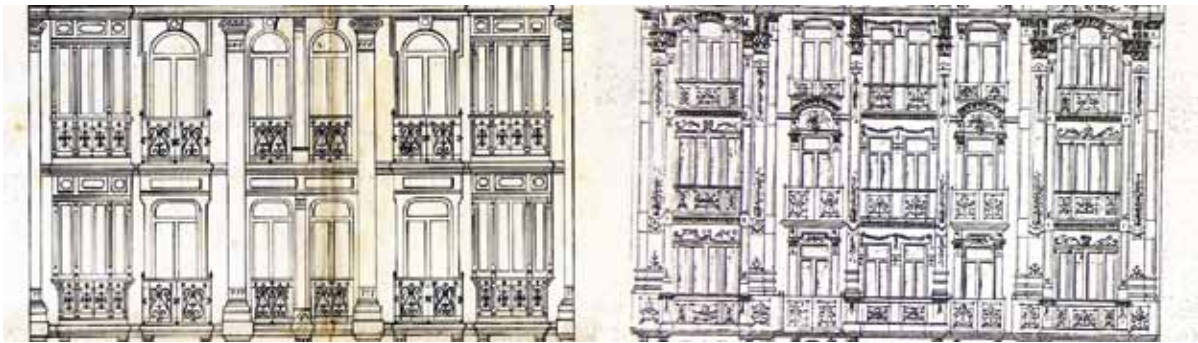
Detalle del diseño de las fachadas de un edificio en la calle Fray Ceferino (izquierda) y de las *Casas del Cuitu* (derecha). El proyecto de las segundas muestra las mismas características que otras obras de Zapata contemporáneas.
